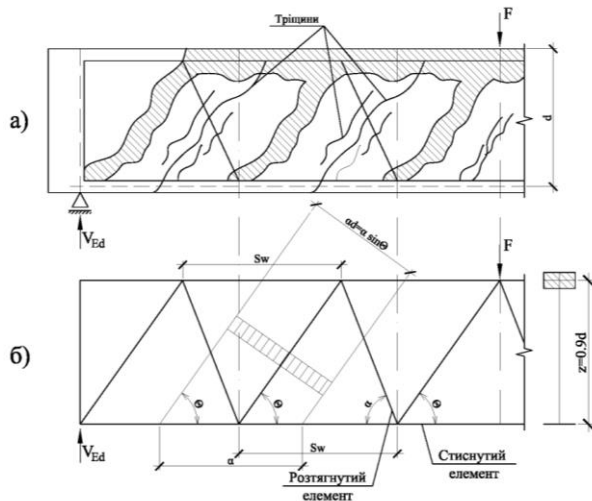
Розрахункова схема для визначення площі поперечної арматури методом фермової аналогії: а – схема утворення тріщин; б – фермова модель згинального елемента.
